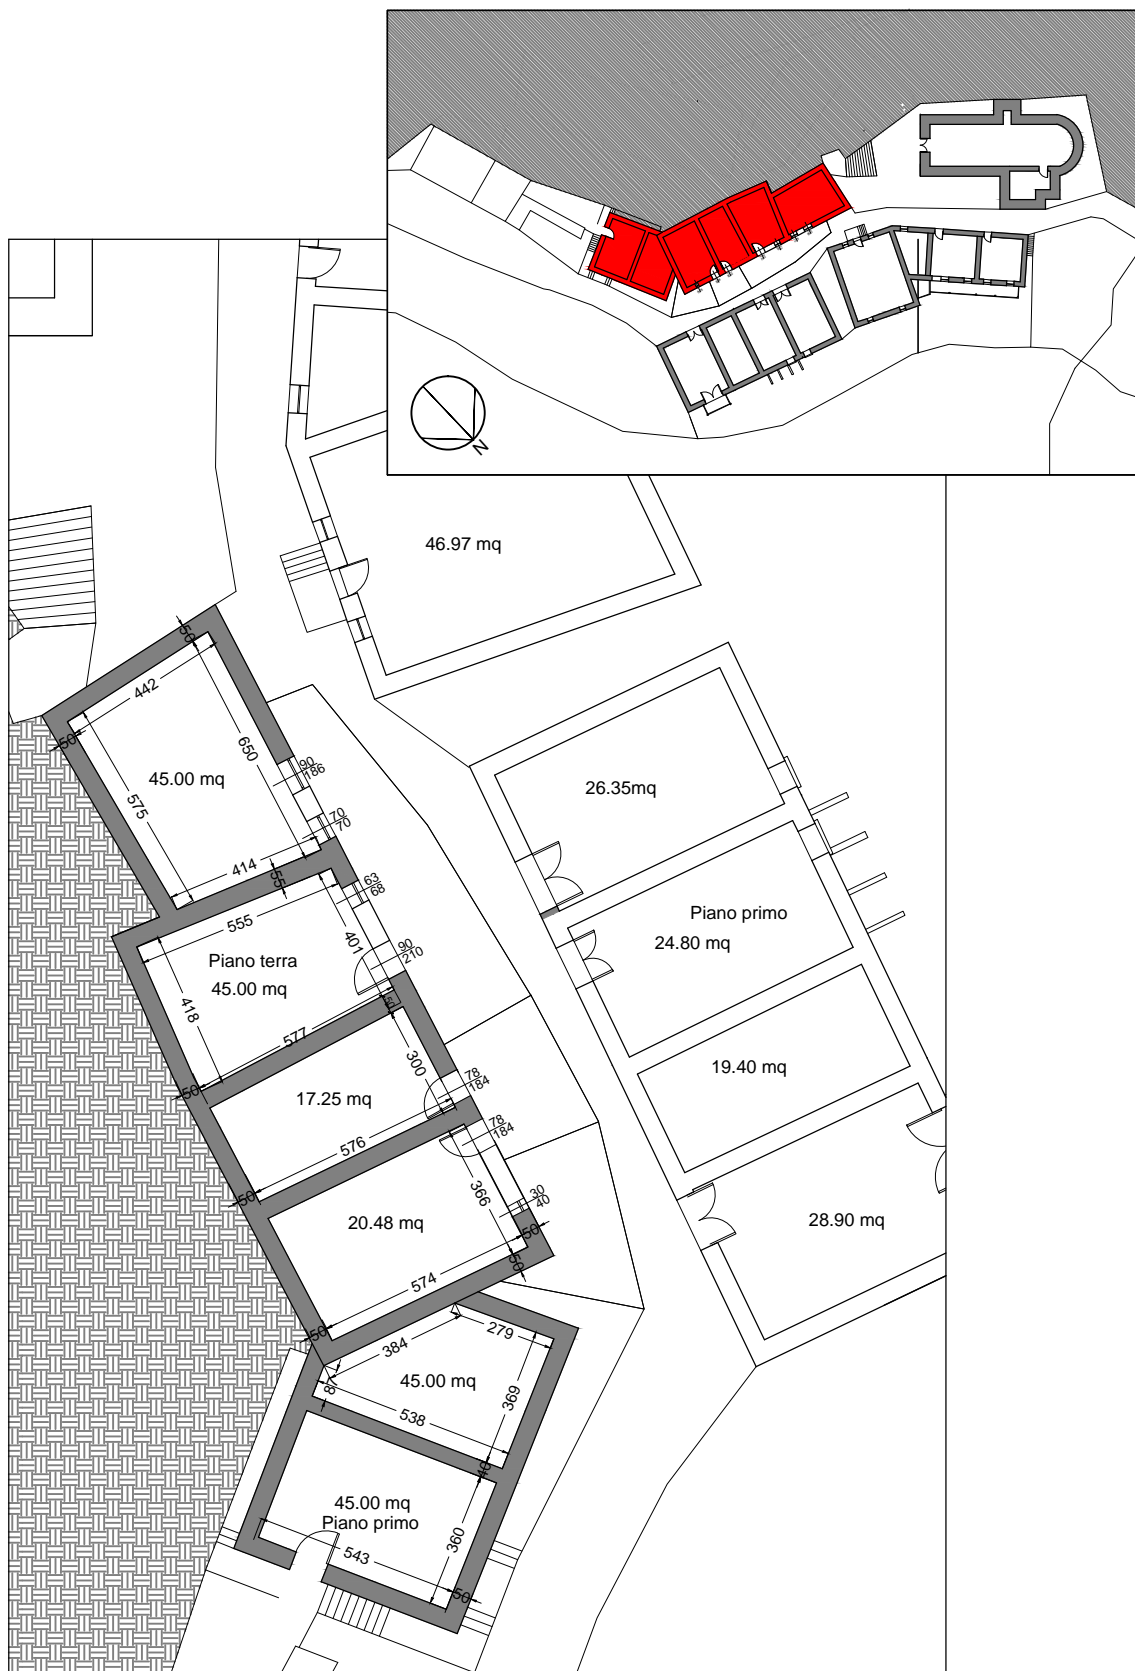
pianta in scala 1:200 degli edifici 98-99-100-104-105
